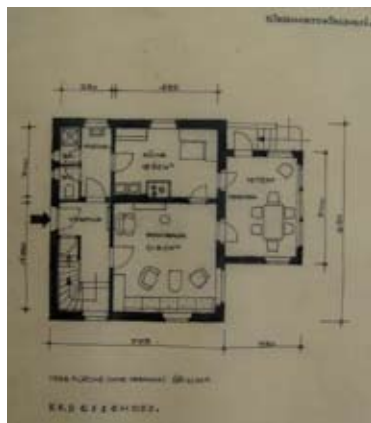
Plan 24.41: Anton Valentin. Sieghartskirchen. Grundriss Erdgeschoß. Ohne Datierung. Architekturzentrum Wien.
